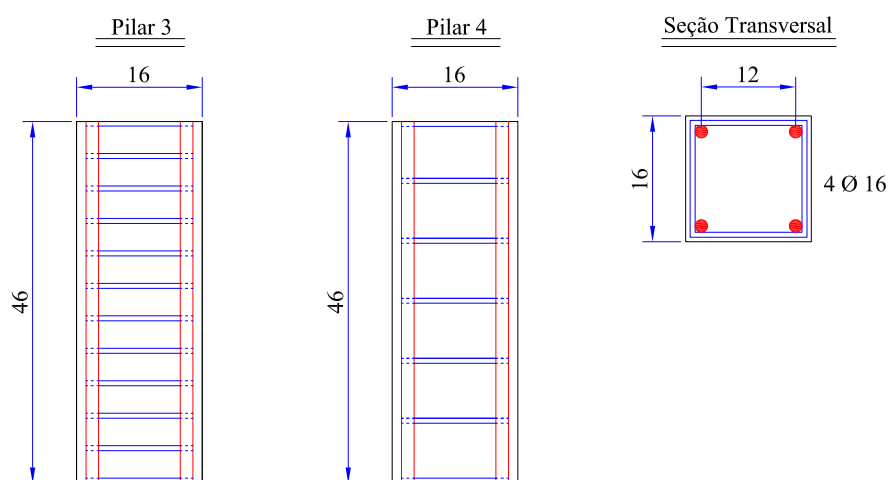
Detalhes da geometria, carregamento e armaduras dos pilares.
